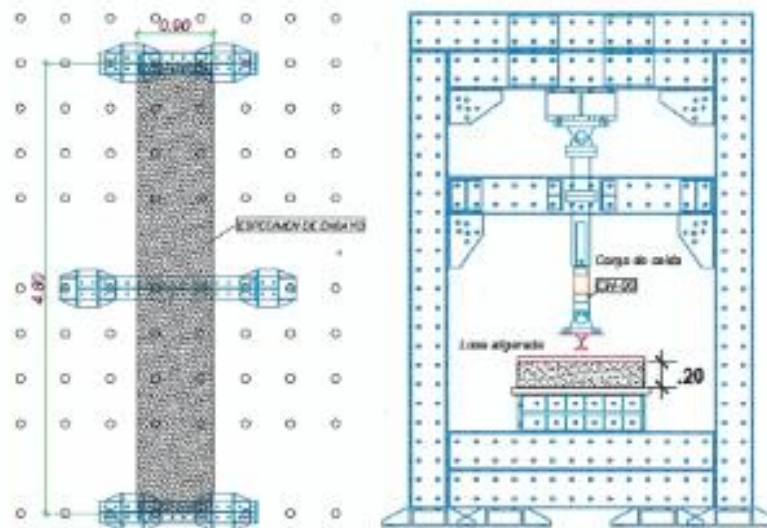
Vista en planta y elevación del mecano de carga y losa aligerada
